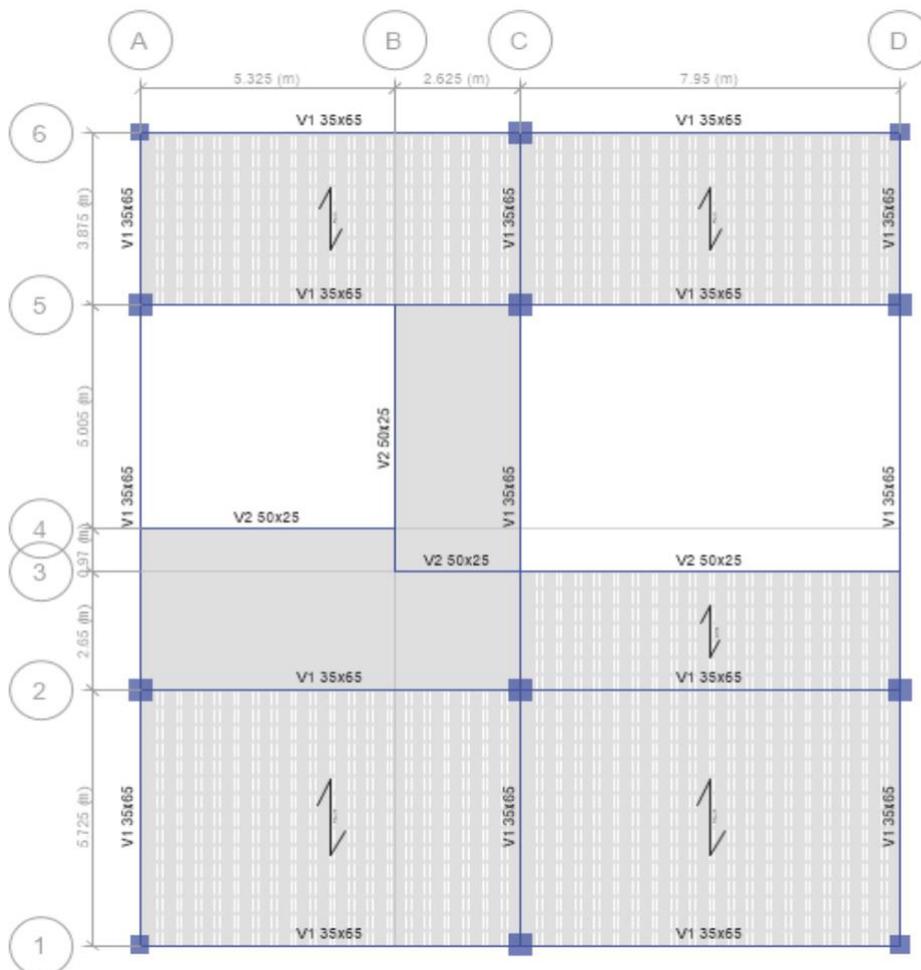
Planta típica de entrepisos referencial en ETABS V.16.2
